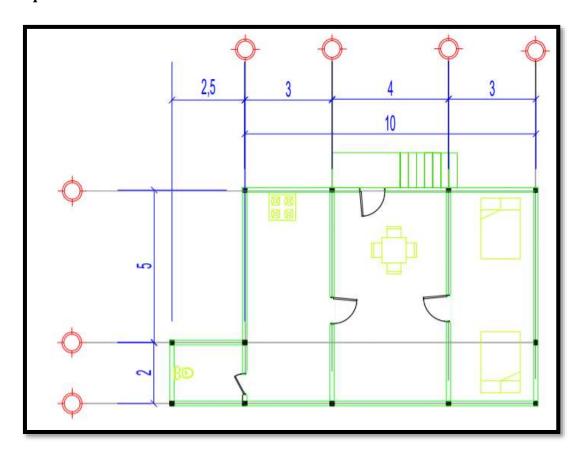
Plano arquitectónico de la vivienda beneficiada, fuente: Autores.
